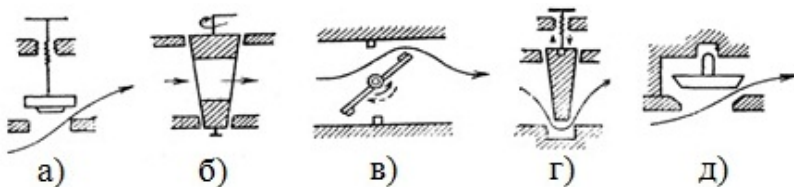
Принципиальные схемы действия водопроводной арматуры:
